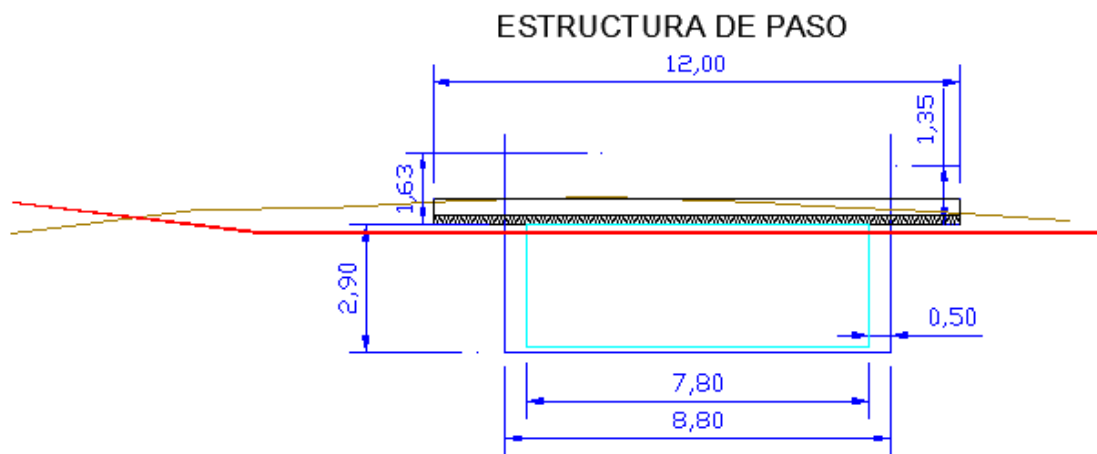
Estructura de paso propuesta. Edet Av. Guzman.
